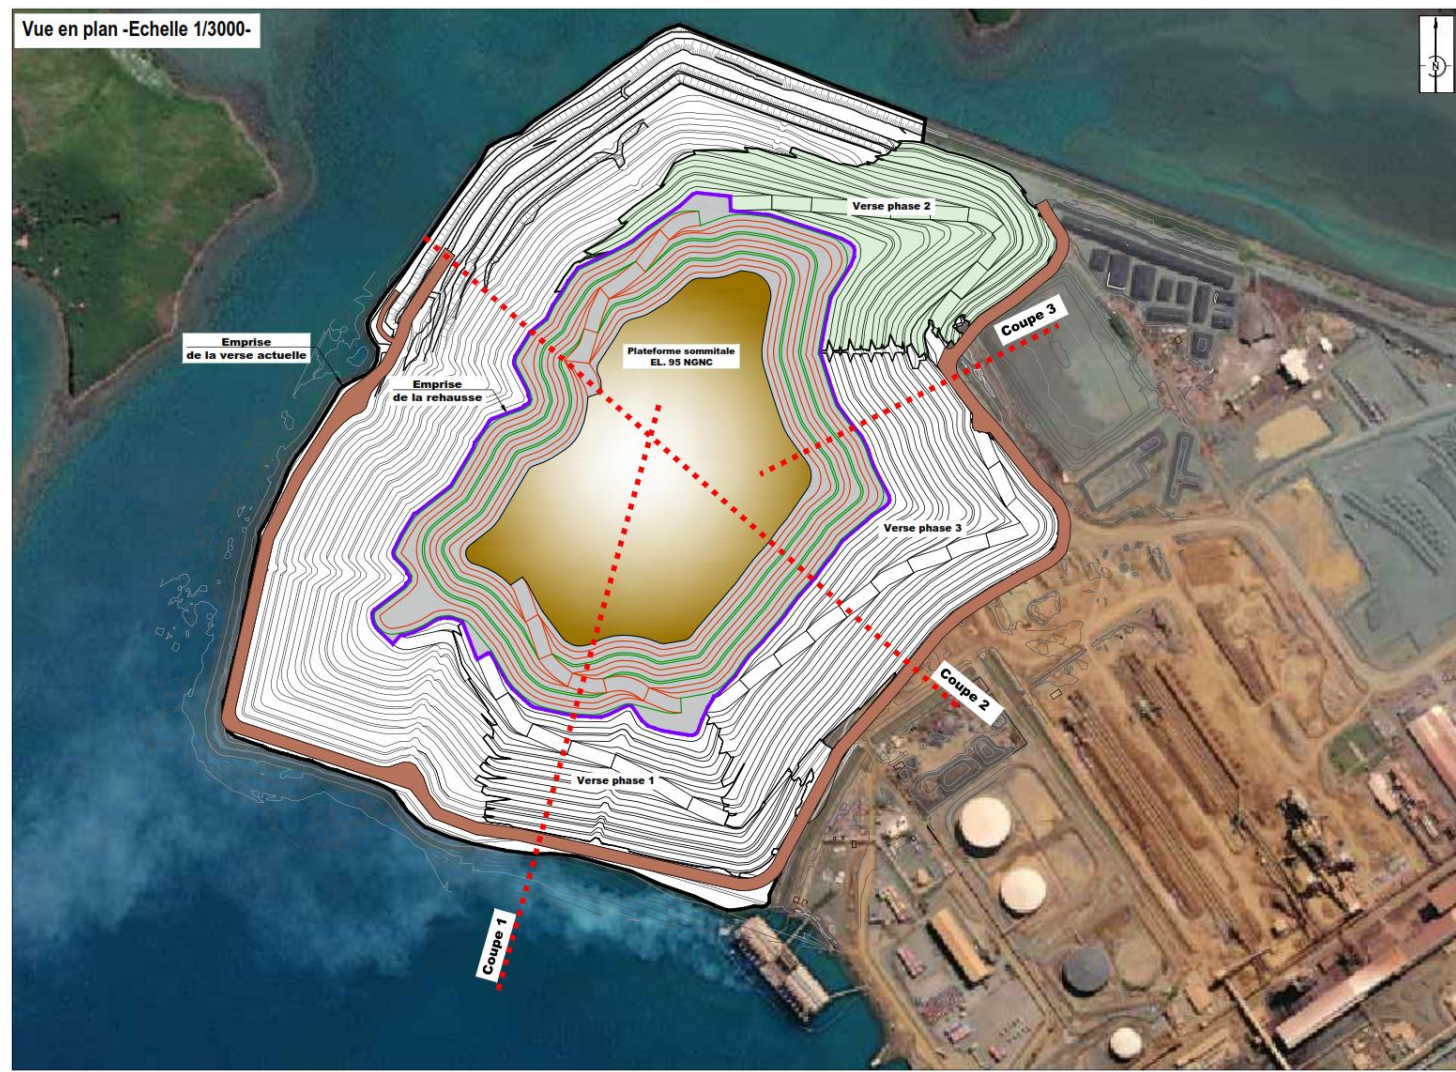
Vue en plan et plan d'implantation des coupes de calcul
